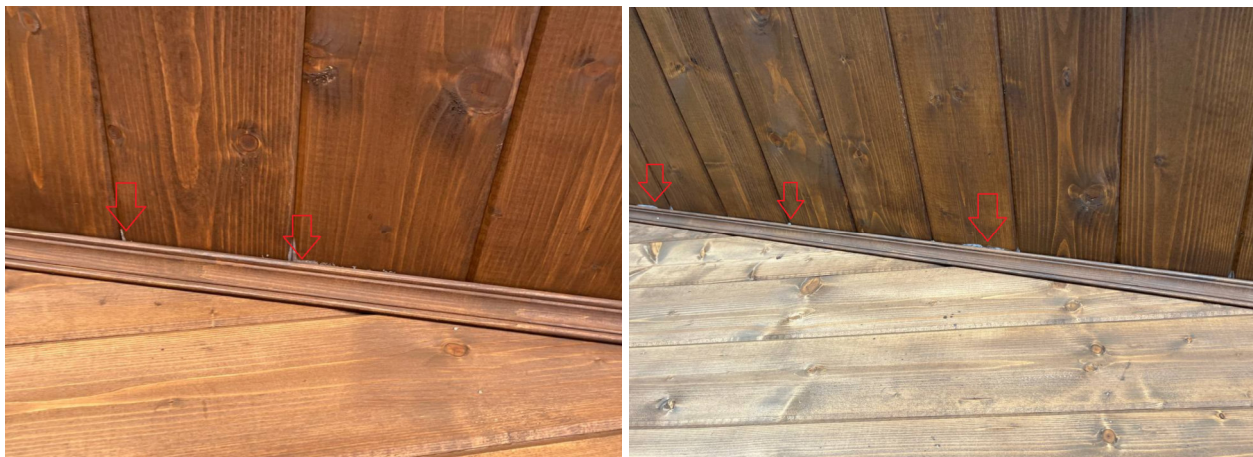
, 102 Наледь на примыкании стен и потолка.
